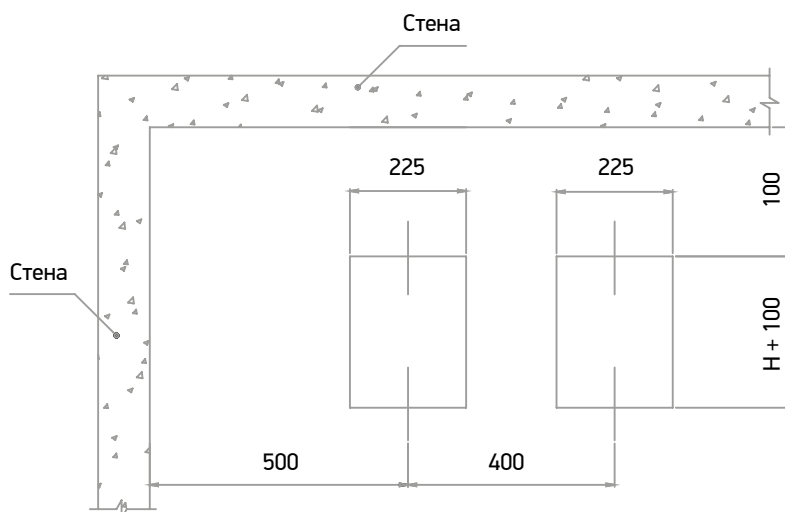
Рекомендуемые размеры отверстий под шинопроводы (вертикальное перекрытие)
